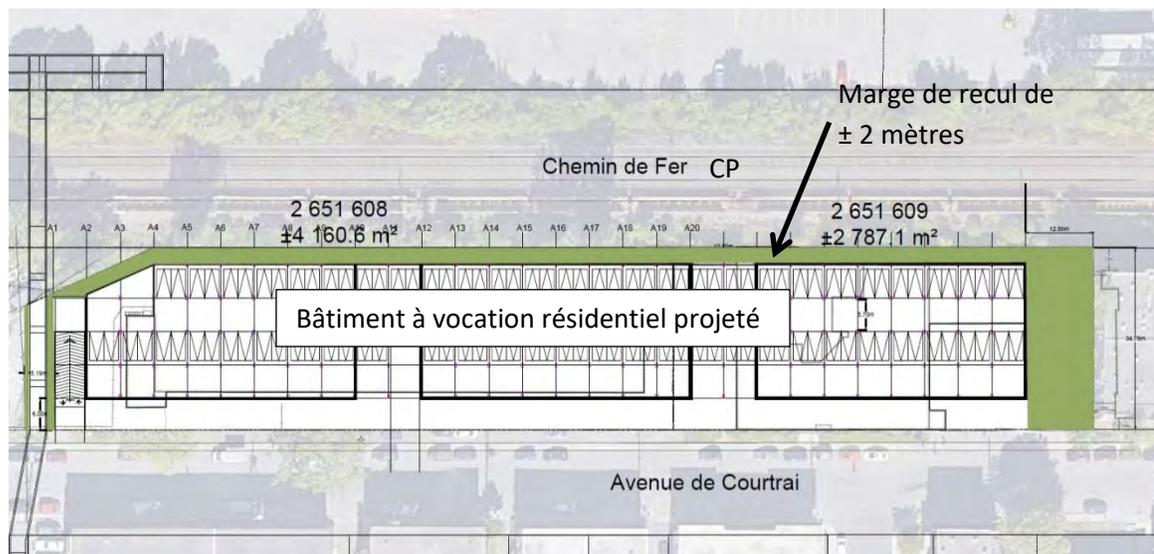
Plan d'ensemble du développement du site projeté (bâtiment projeté et voies ferrées CP)
